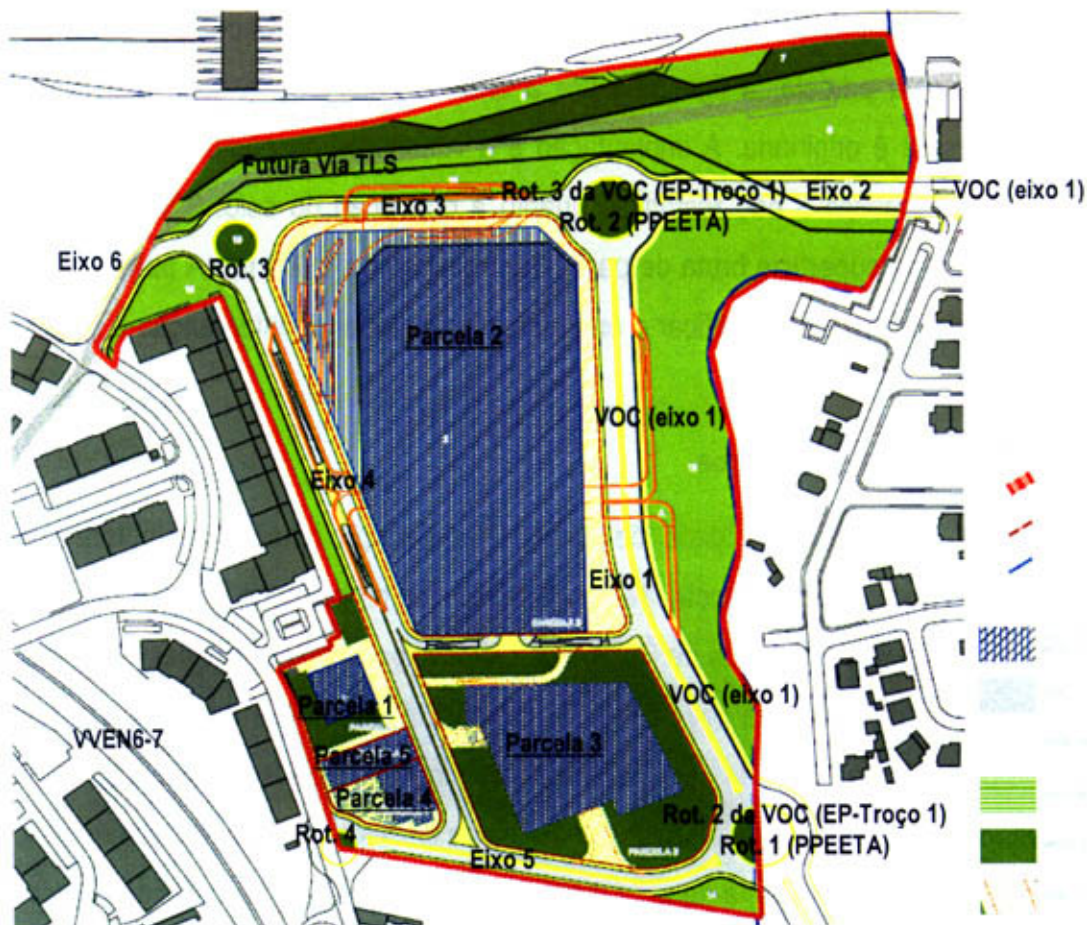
Planta de Zonamento proposta no PPEETA
